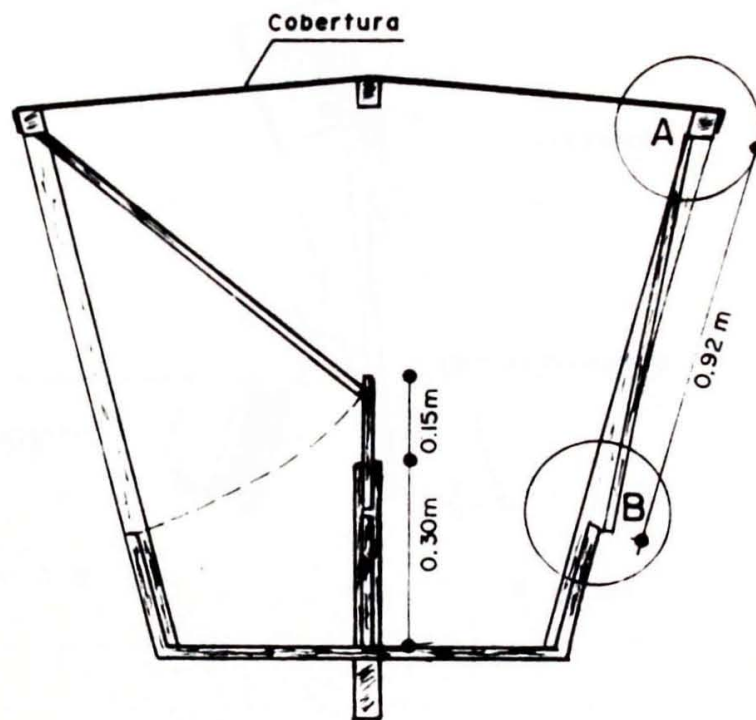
Planta baixa do saleiro automático-unidade (SA-1)
